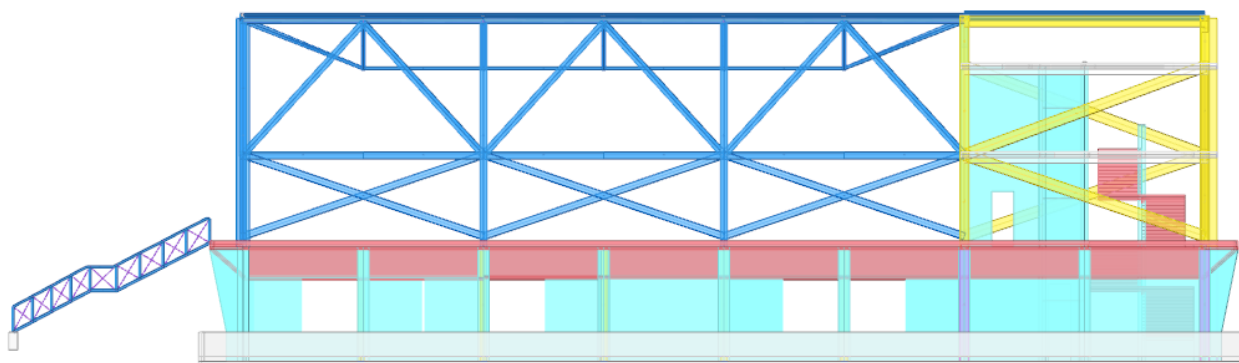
Vista 3D del Modello Strutturale FEM – Corpo A – Vista Prospettica Longitudinale – Stato di Progetto
